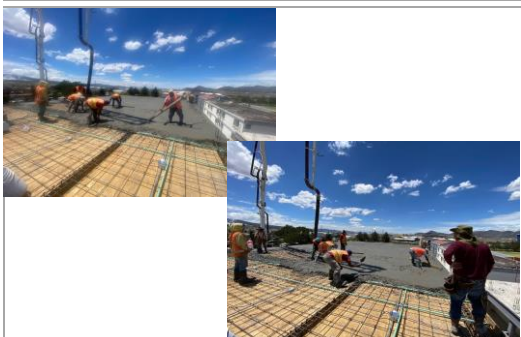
Colados de concreto en 50% de la superficie total del edificio en columnas, traves y de losa.
